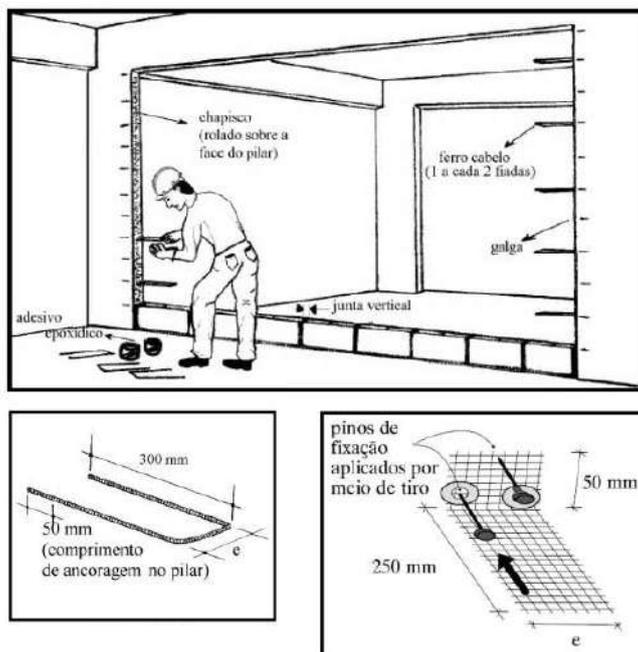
Ilustração do esquema de ligação alvenaria de vedação e pilar.
